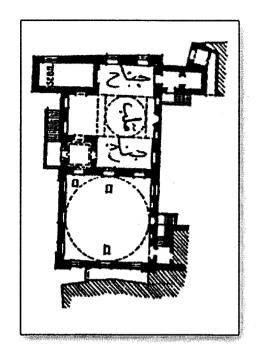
جامع أبي دلف (مسقط أفقي) عن، هرتزفلد
